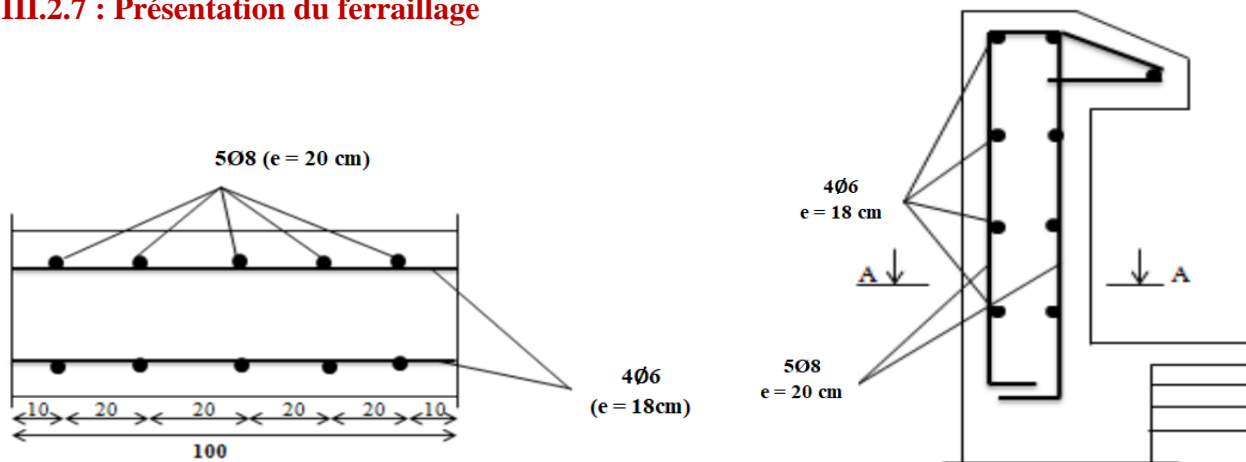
Schéma du ferrailage de l'acrotère.
